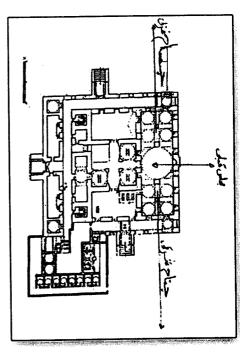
جامع أوج شرفلي بأدرنة بتركيا (مسقط أفقي) عن ، Stierlin
